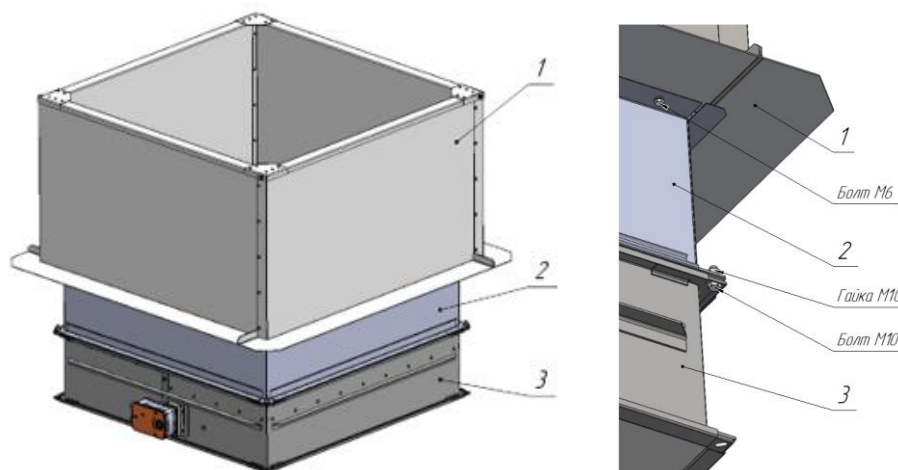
Установка принадлежностей в универсальный монтажный стакан
